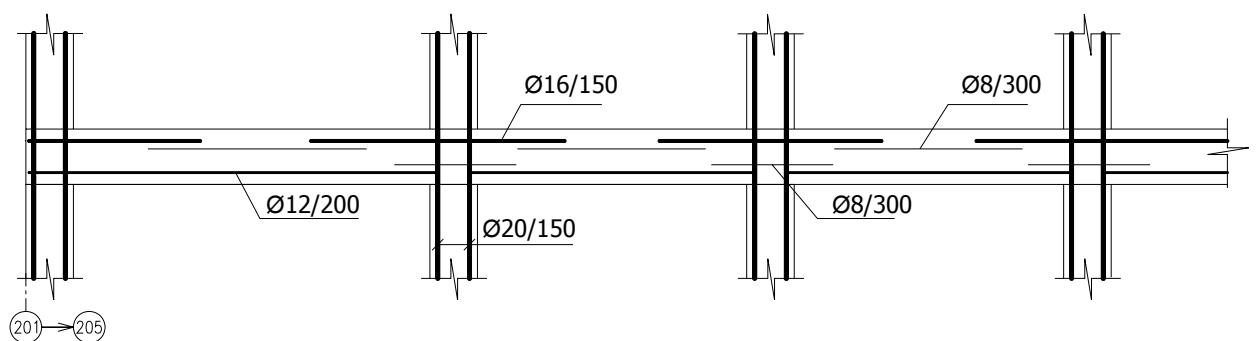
Фрагмент верхнего армирования плиты перекрытия
